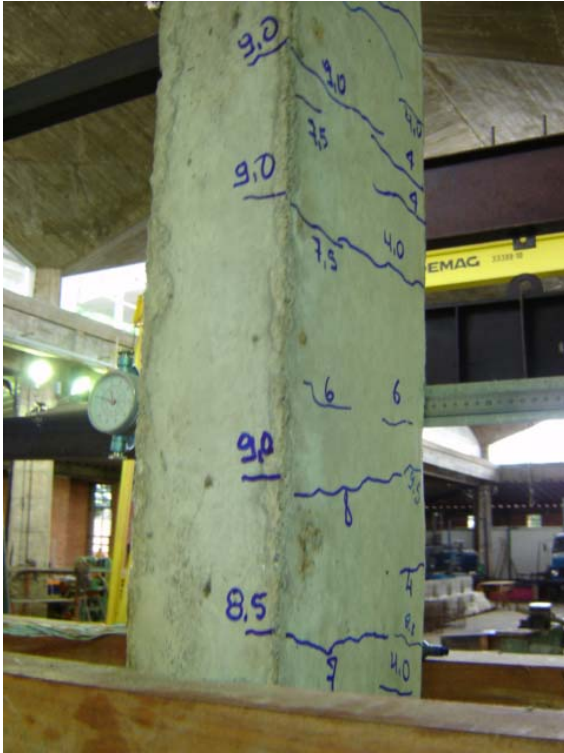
Fissuras do pilar PFN60-3
